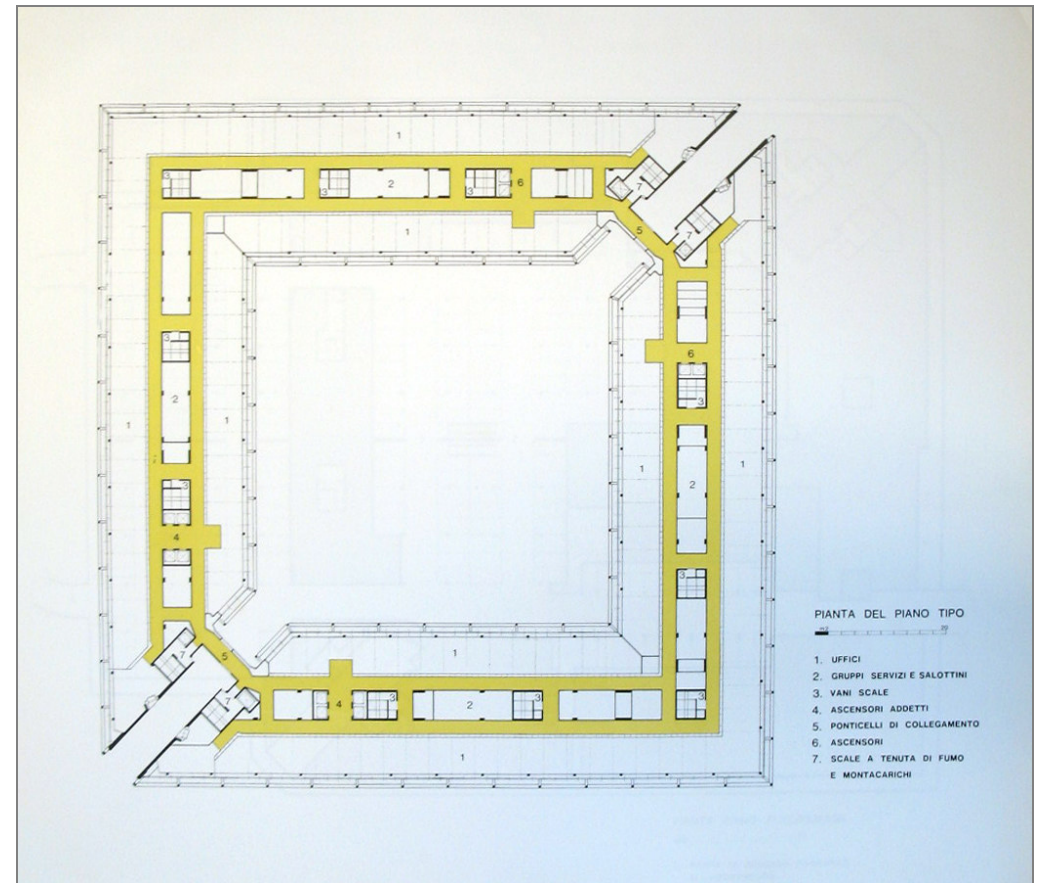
pianta del piano tipo (archivio studio alberti matti ferrari)
